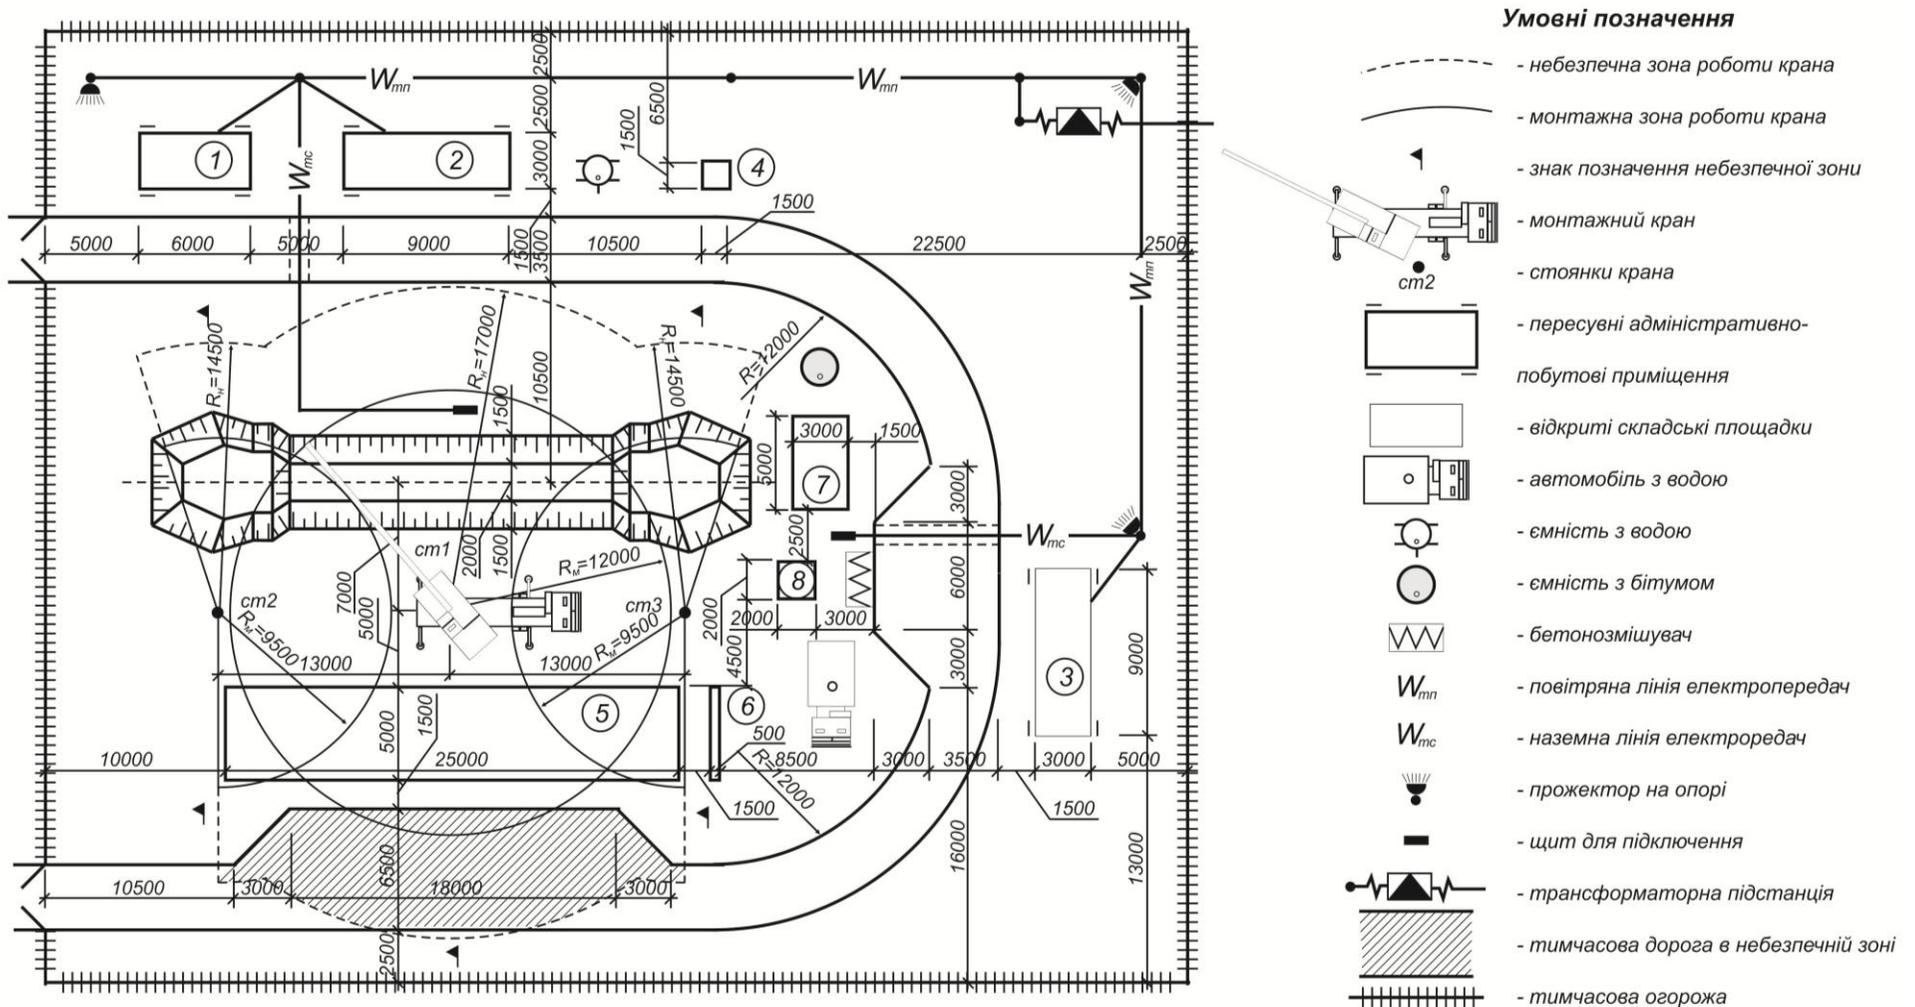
Будівельний генеральний план зведення водопропускної труби:
